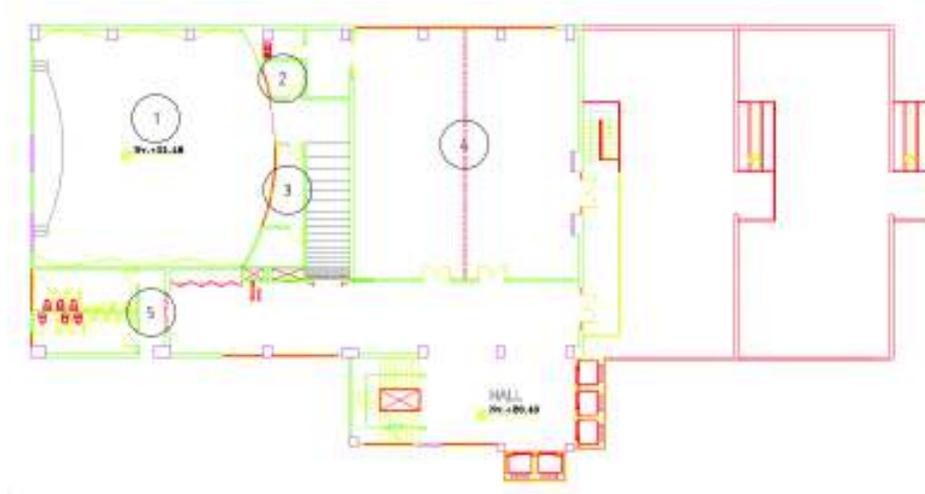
Distribución EARME primera etapa, Planta Quinto piso
